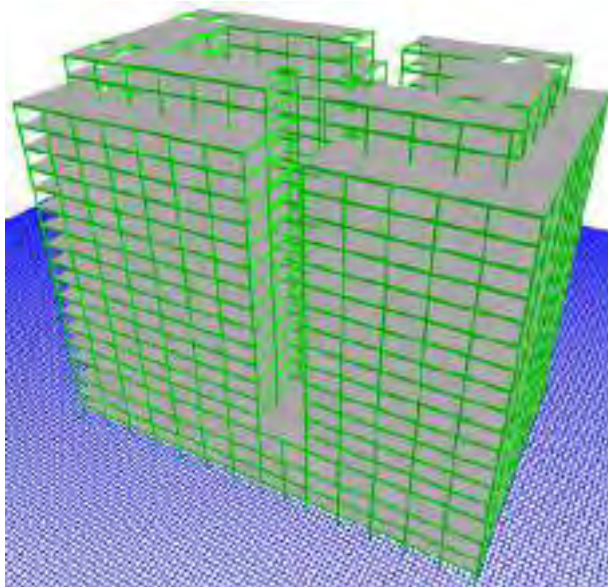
Denah Struktur Apartement Bale Hinggil
